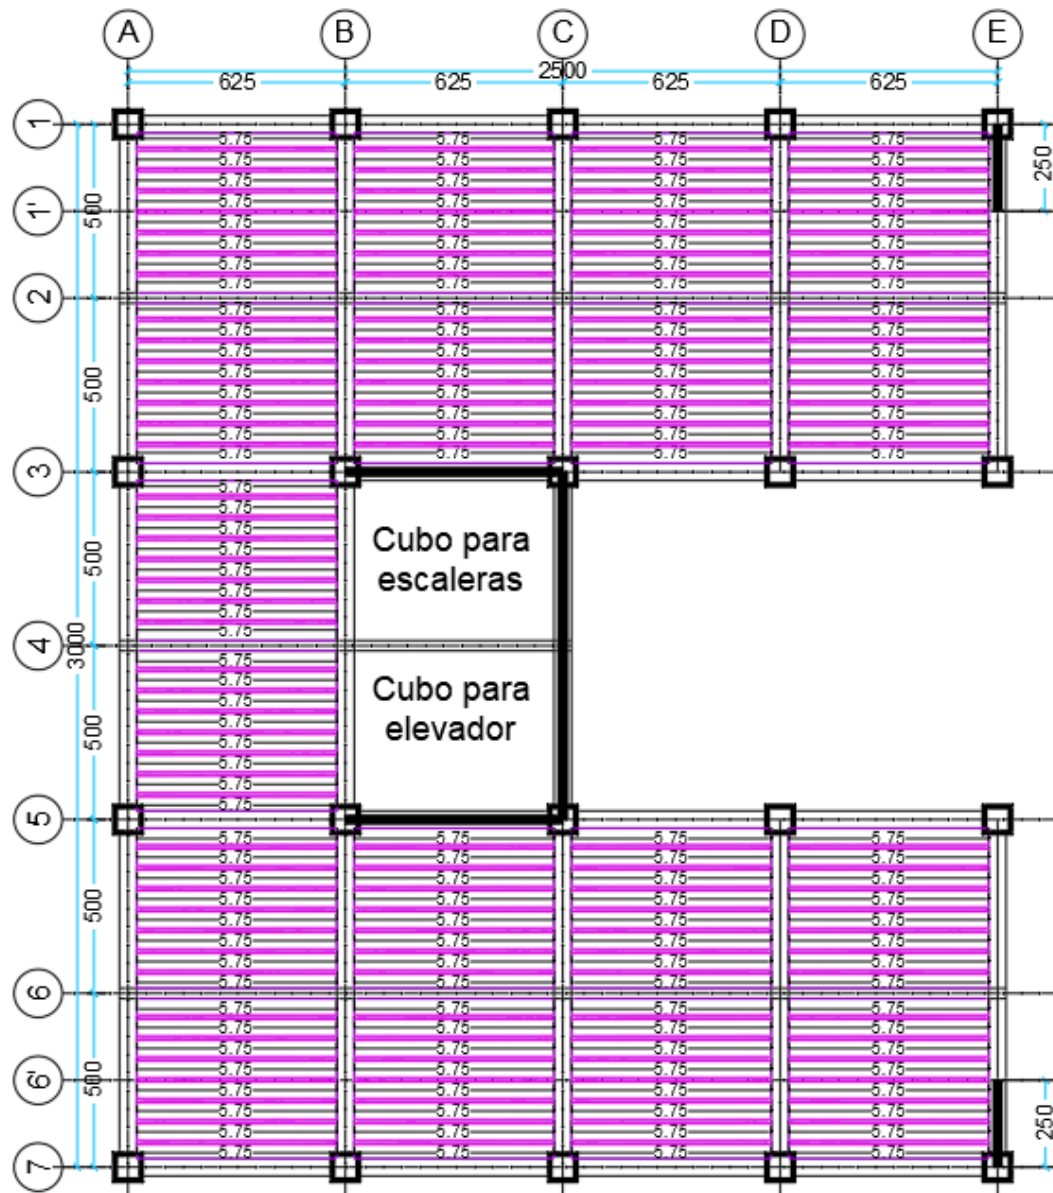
Planta tipo con despiece de panel de poliestireno. (Elaboración propia)
